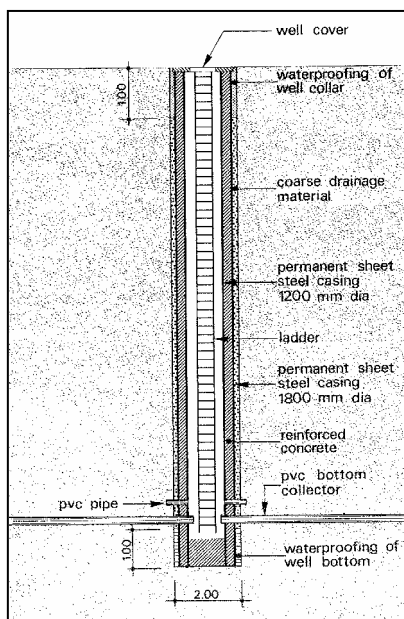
Schema di un pozzo drenante di ispezione avente anche una funzione strutturale (da COLLOTTA et al., 1988) -
